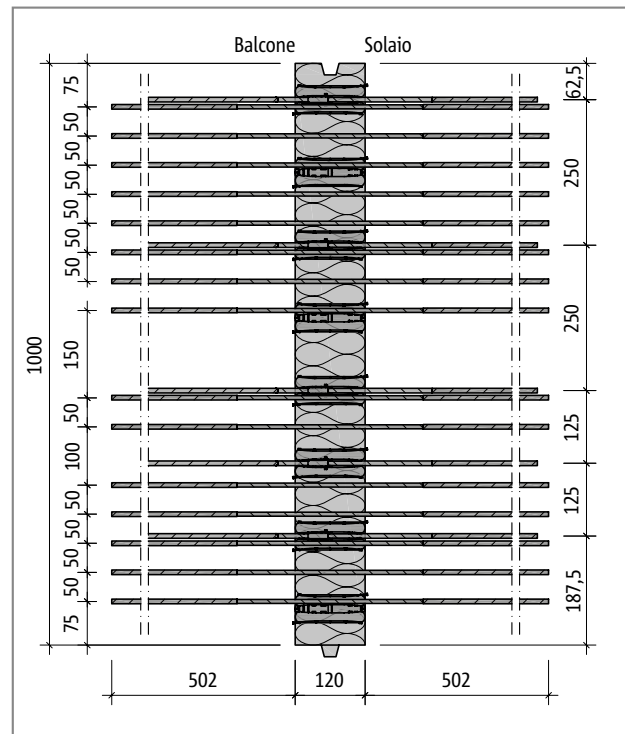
Schöck Isokorb® tipo KXT50: pianta del prodotto
